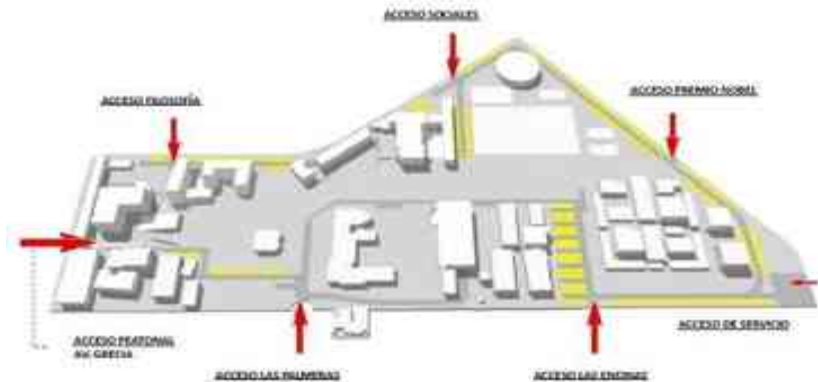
Plan maestro Juan Campos Millas Distribución de estacionamientos.
